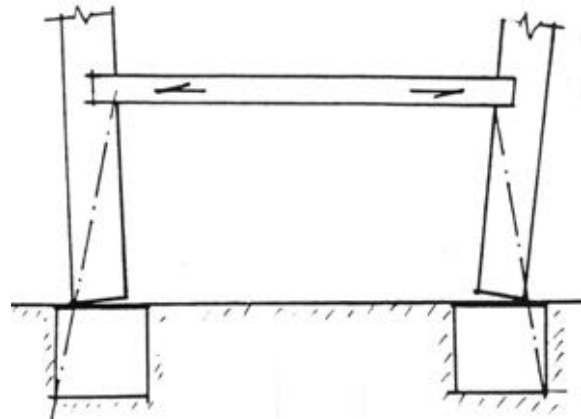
a : EMPUJE SIMÉTRICO DEL FORJADO
